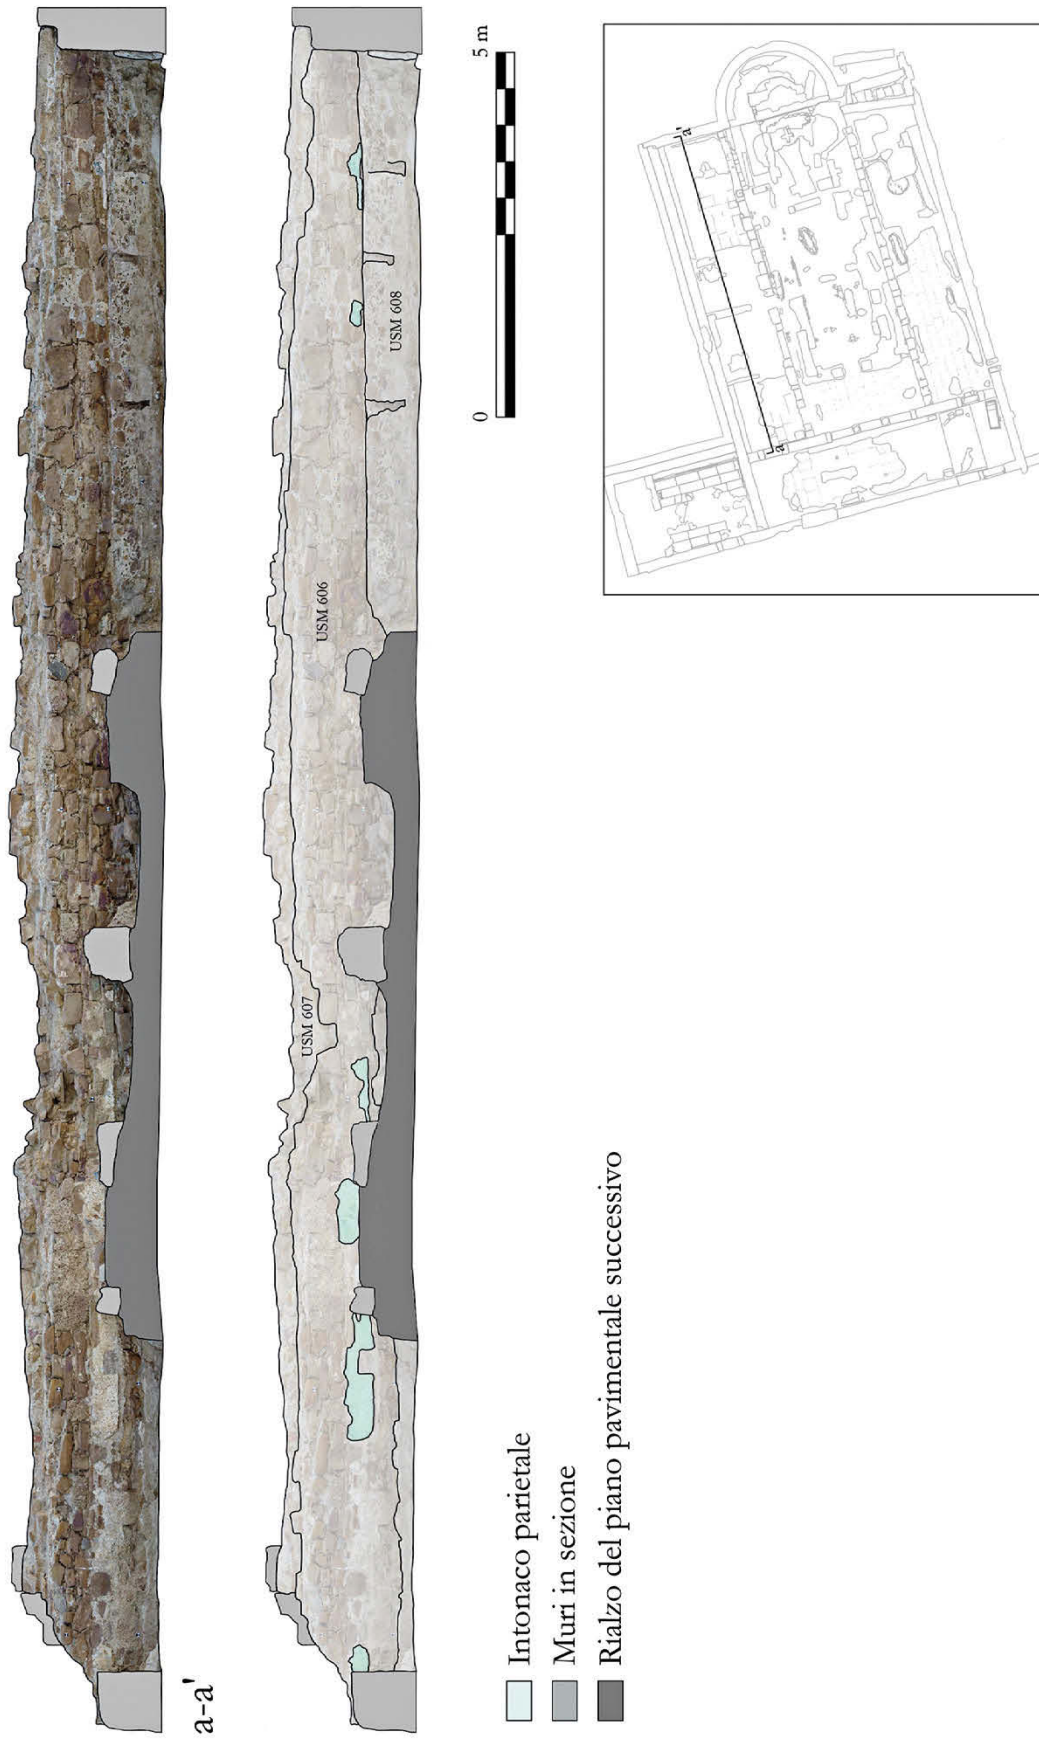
Navata N. Prospetto e sezione longitudinale (a-a') (foto ed el. C. Mendolia; © Archivio disegni SAIA NIG 8510).
